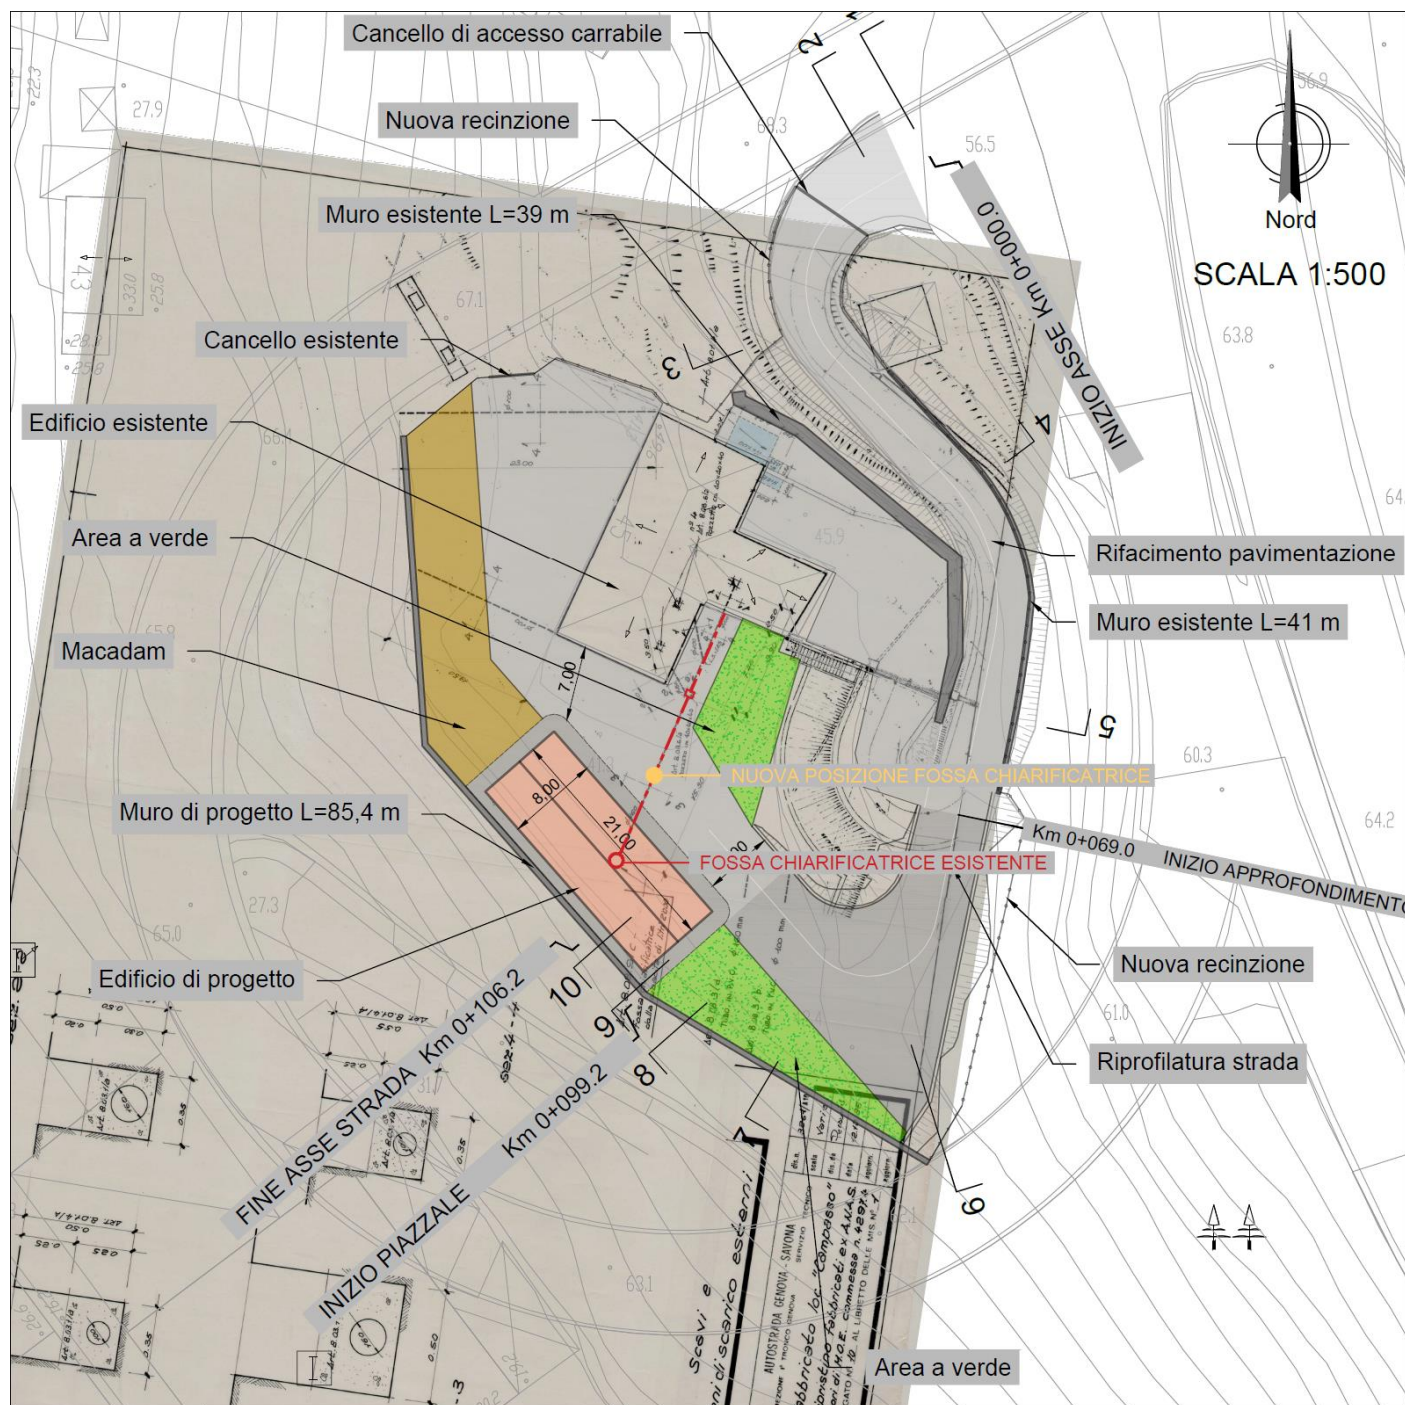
Sovrapposto Planimetria di progetto ed Elaborato progettuale fornito da Autostrade “Fabbricato loc. Campasso – Rispristino fabbricati Ex ANAS – Lavori di M.O.E. commessa n. 4297.4” – Individuazione fossa chiarificatrice esistente (in rosso) e nuova posizione (in arancio)
